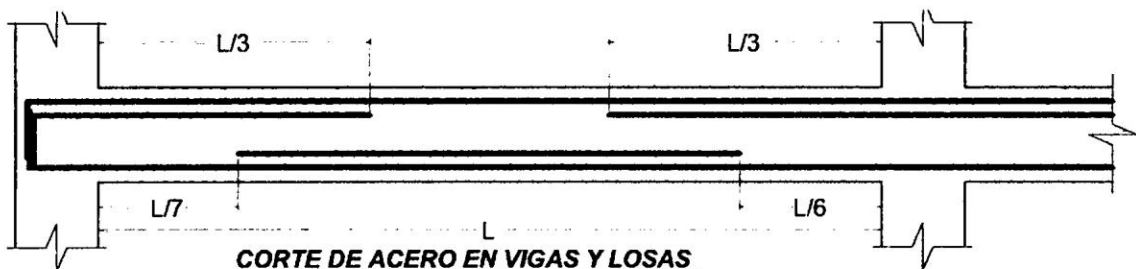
Criterio practico para corte de acero longitudinal en vigas
